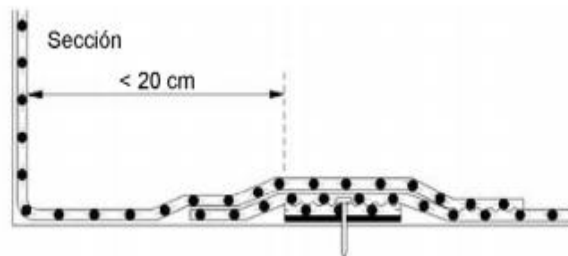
Alzado anclaje perimetral. Fuente: Figura 26 Norma UNE 104416:2009
